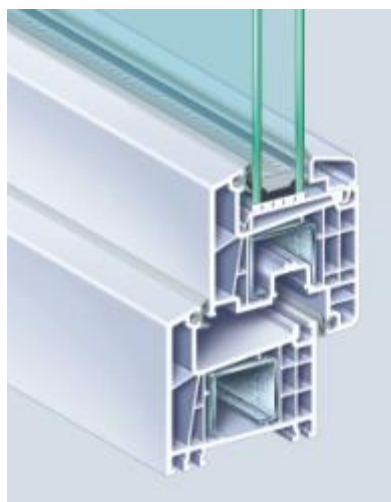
ПВХ профиль однокамерного стеклопакета со стальными вкладышами
